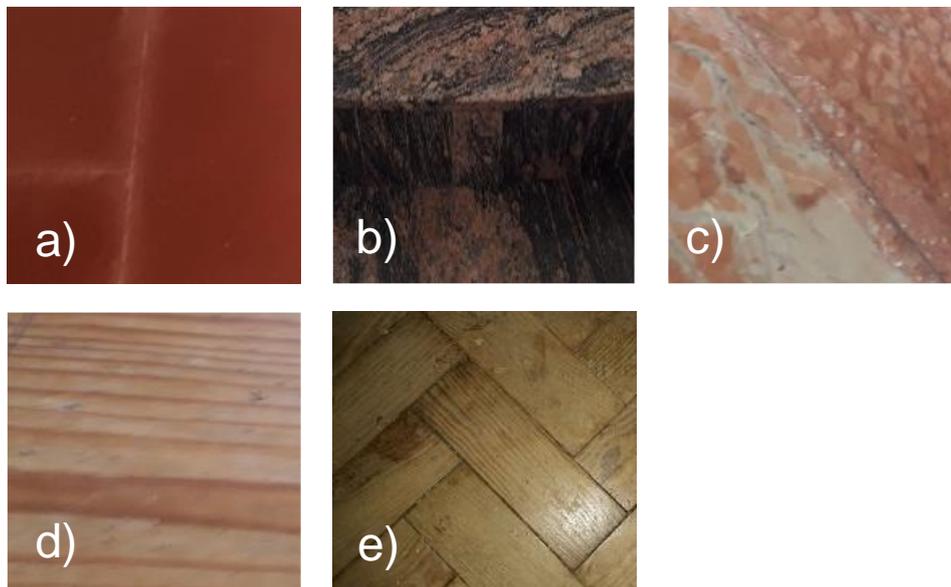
Estereotomia dos pavimentos interiores: a) tijoleira cerâmica; b) mármore rosa e verde; c) pedra lioz; d) madeira pinheiro bravo; e) *parquet* (Fonte: de autor).
